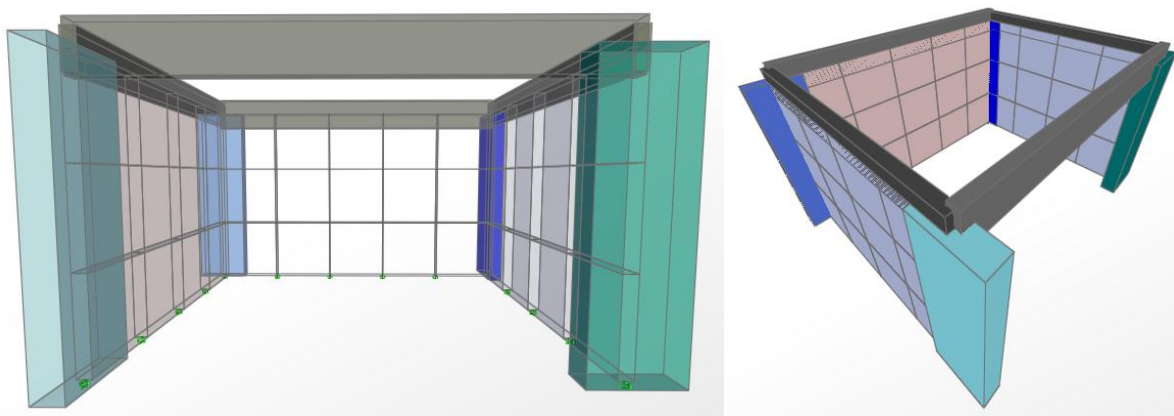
Paredes de Cisalhamento - Fosso do elevador
